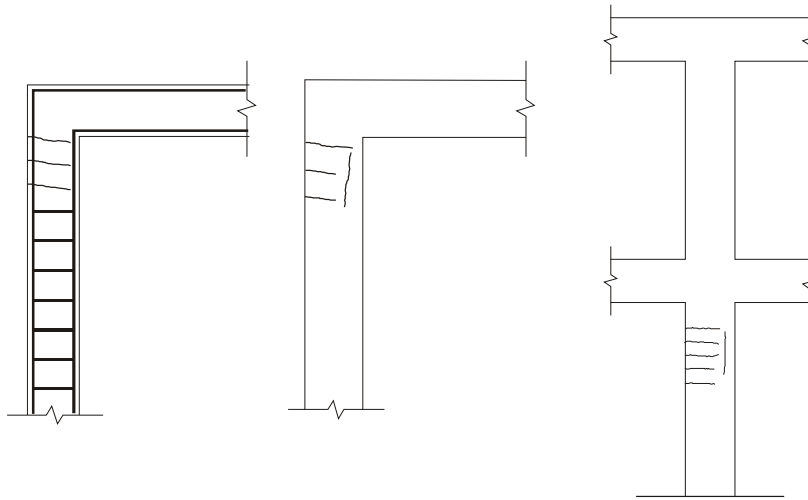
Fissuras em pilares provocadas pela flexão composta e flambagem
